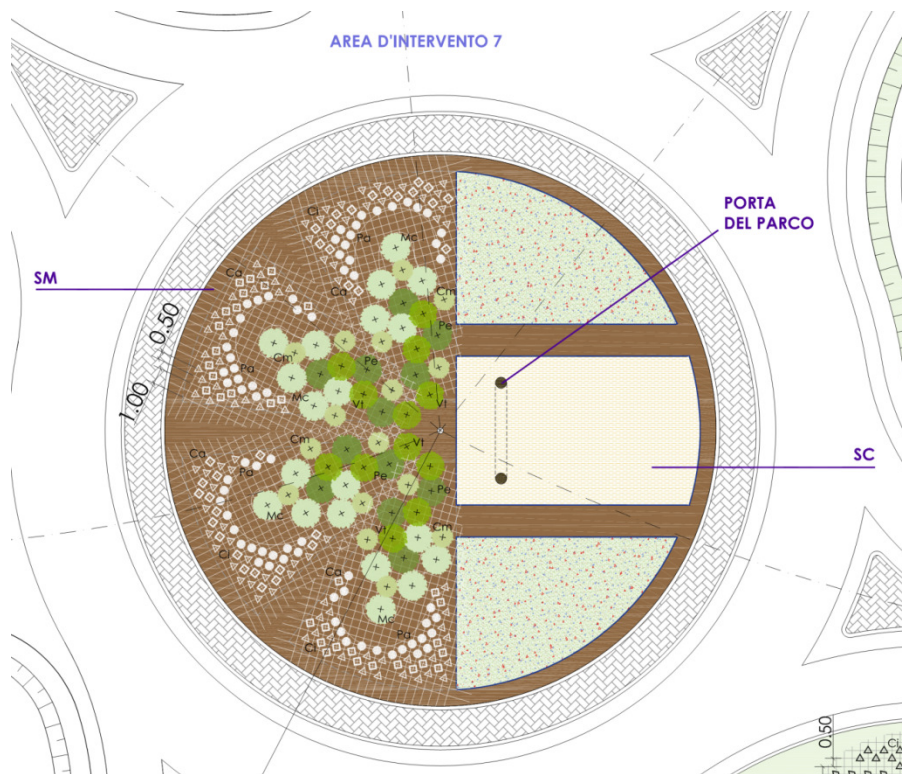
Planimetria di progetto della sistemazione della rotatoria
